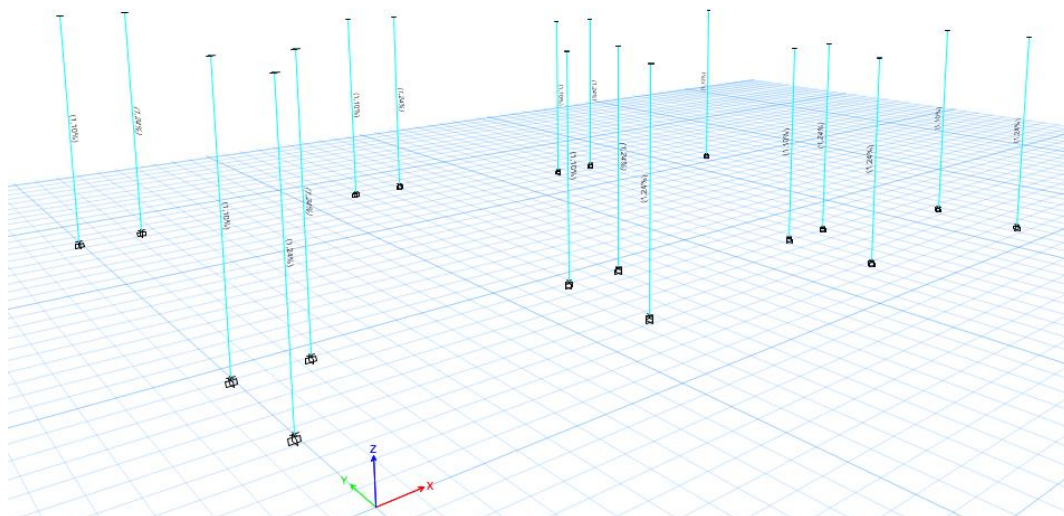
Refuerzo longitudinal columnas en aulas de 1-11 en %
